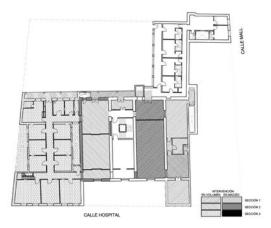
Plano de la planta piso segundo, con indicación de las diferentes intervenciones (Jordi Salvat)
